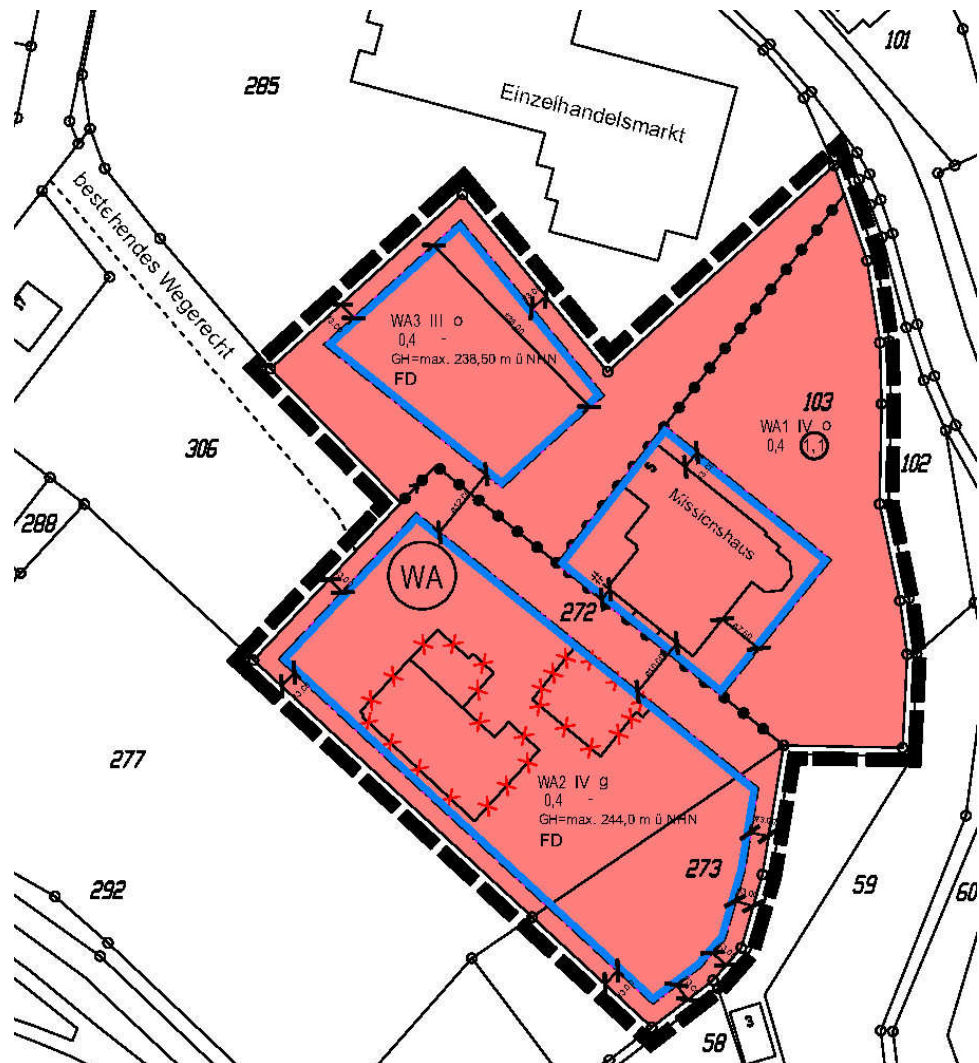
7. Änderung Bebauungsplan D3 'Missionshaus'
